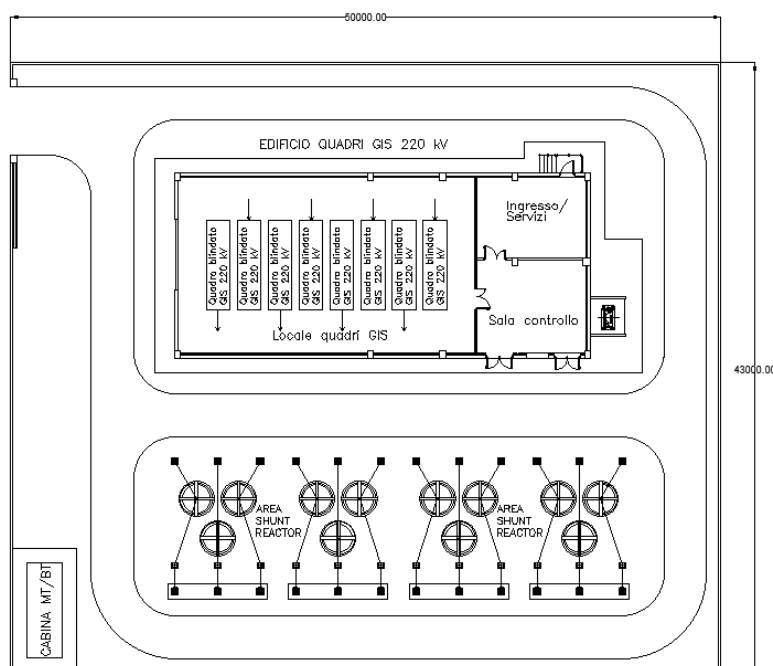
20: Vista in pianta della stazione di compensazione e sezionamento
